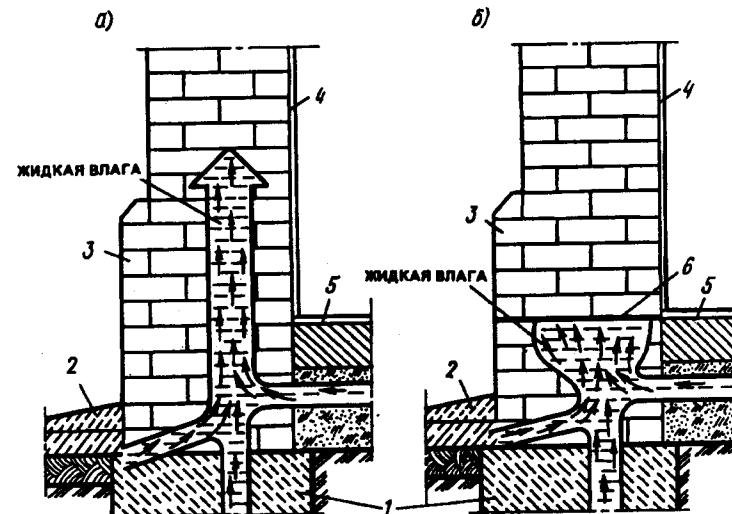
Увлажнение конструкции цокольного узла без гидроизоляции (а) и с гидроизоляцией (б)
